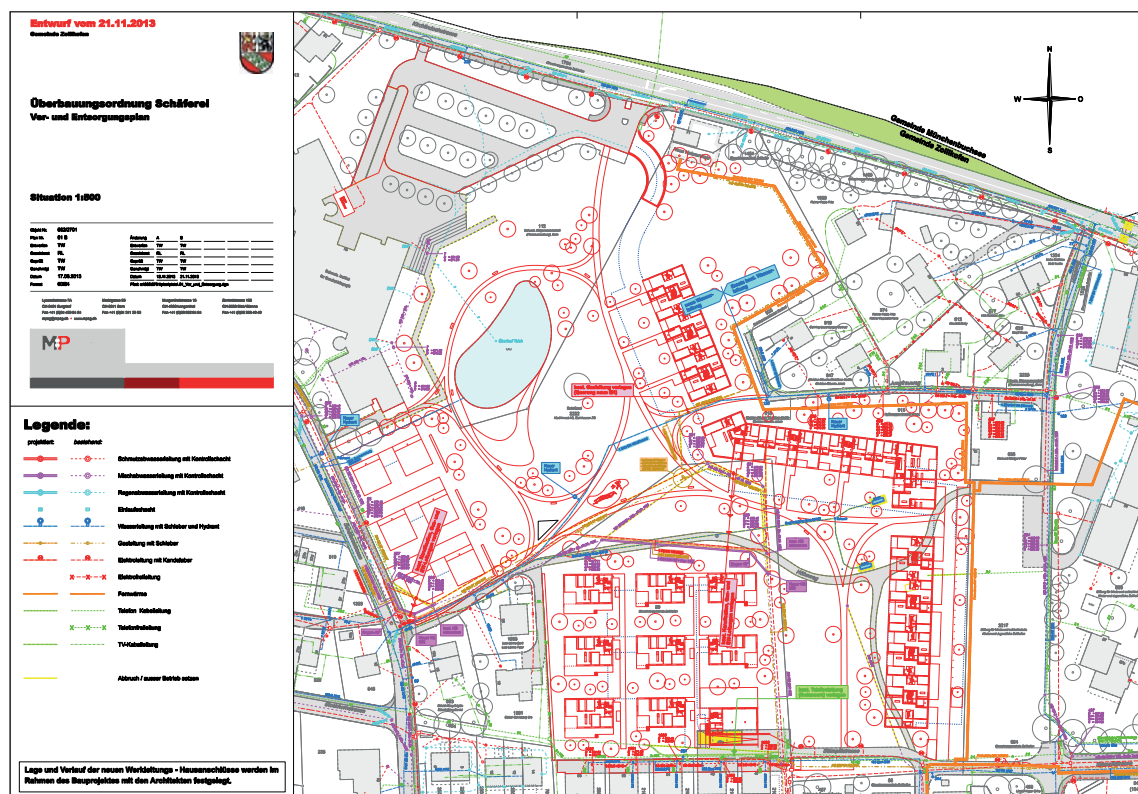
Ver- und Entsorgungsplan (Verkleinerung)
